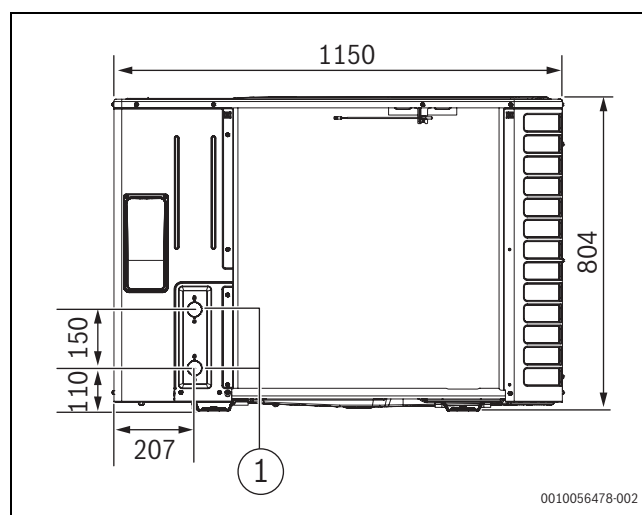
Abmessungen und hydraulische Anschlüsse der Wärmepumpe, Rückansicht
